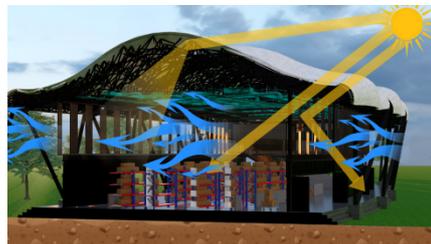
(a) Bentuk Bangunan dan Fasad 1
